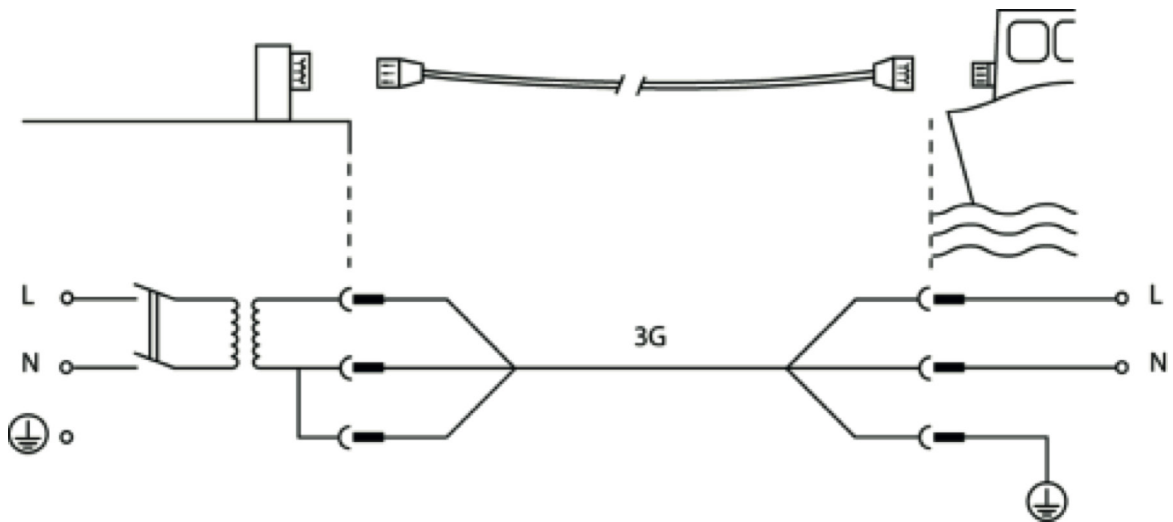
B.5 - Collegamento ad un'alimentazione monofase attraverso un trasformatore di isolamento montato sulla banchina
